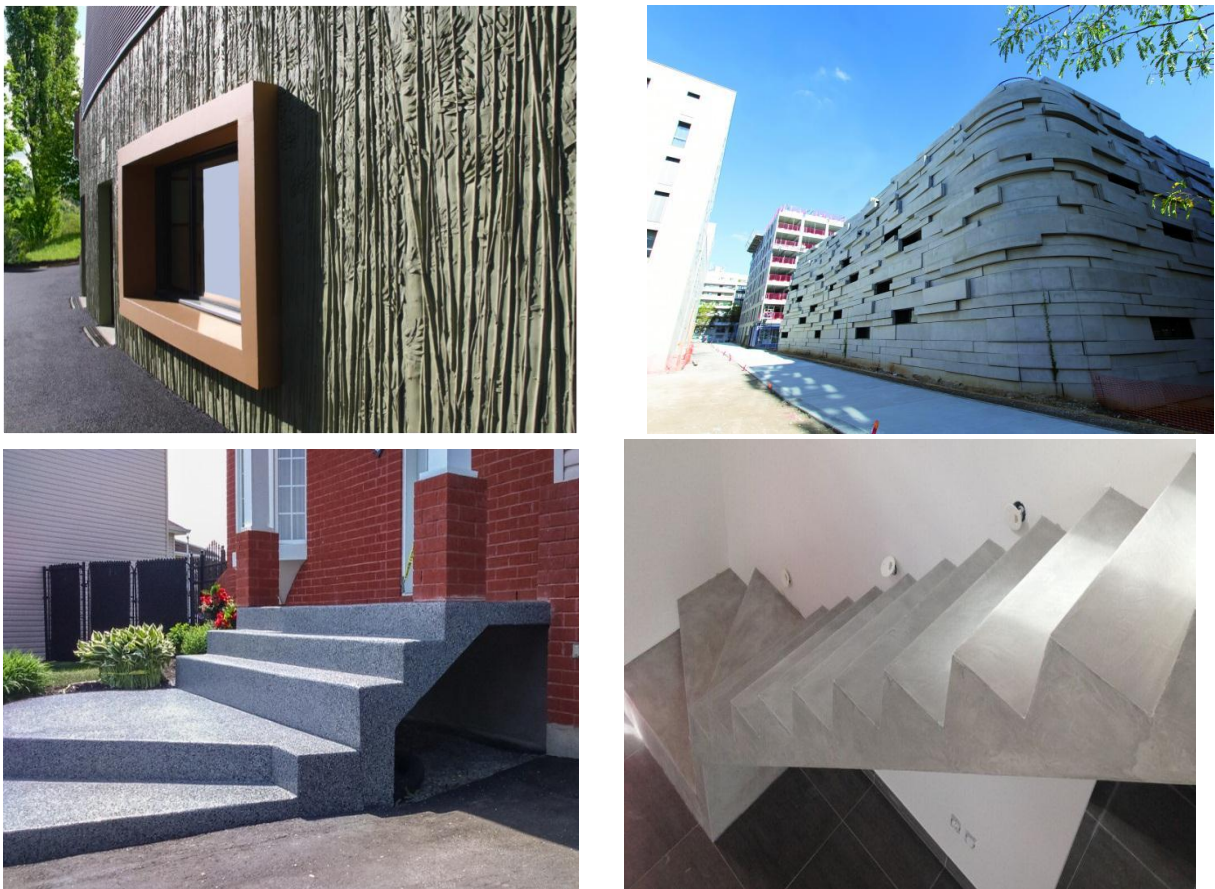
Façades et marches d'escalier en béton polymère pour bâtiment.
